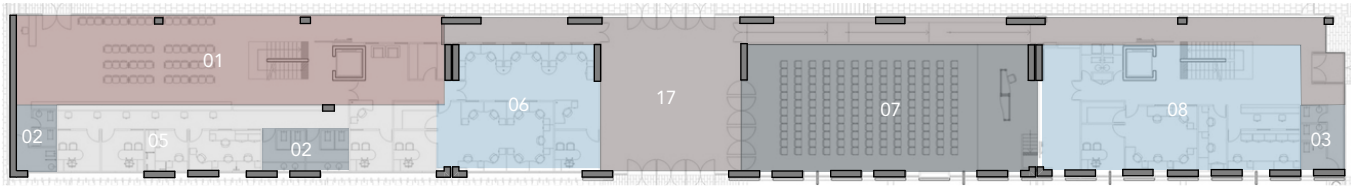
Distribución de áreas planta baja de SERVIU (2015). Elaborado por el autor
